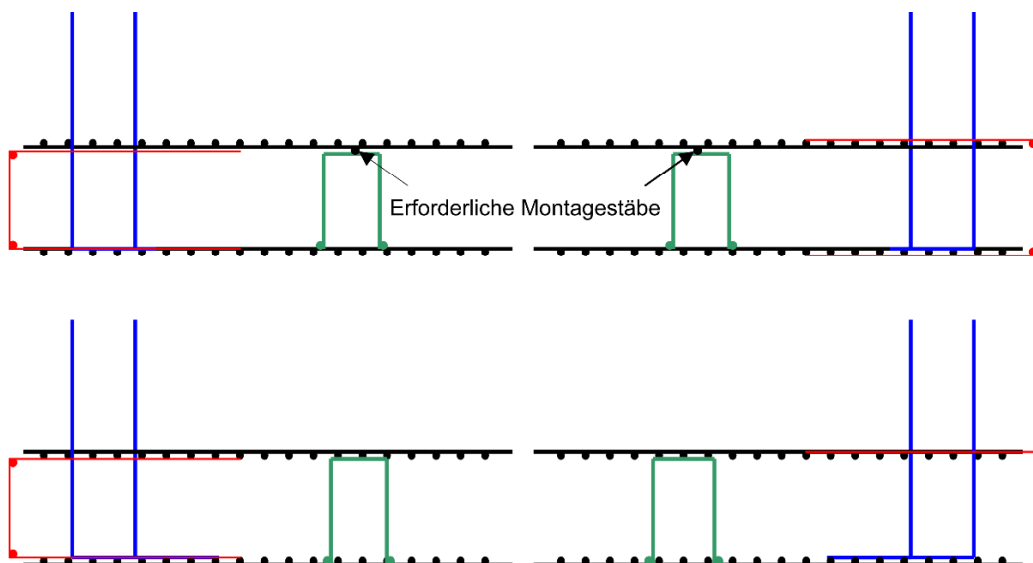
Eckverbügelung in einer horizontalen Platte mit einliegendem (oben) und umfassendem Bügel (unten) und erforderlichen Montagestäben
